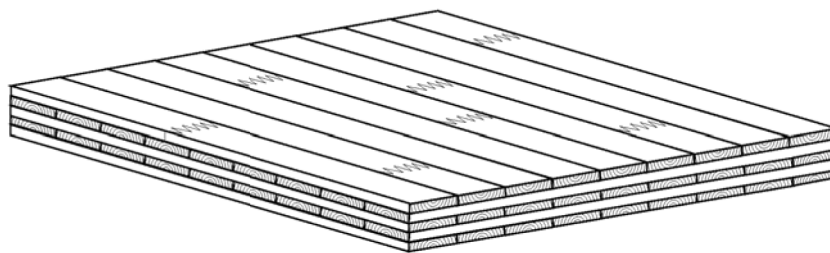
Ejemplo de tablero de paneles contralaminados
